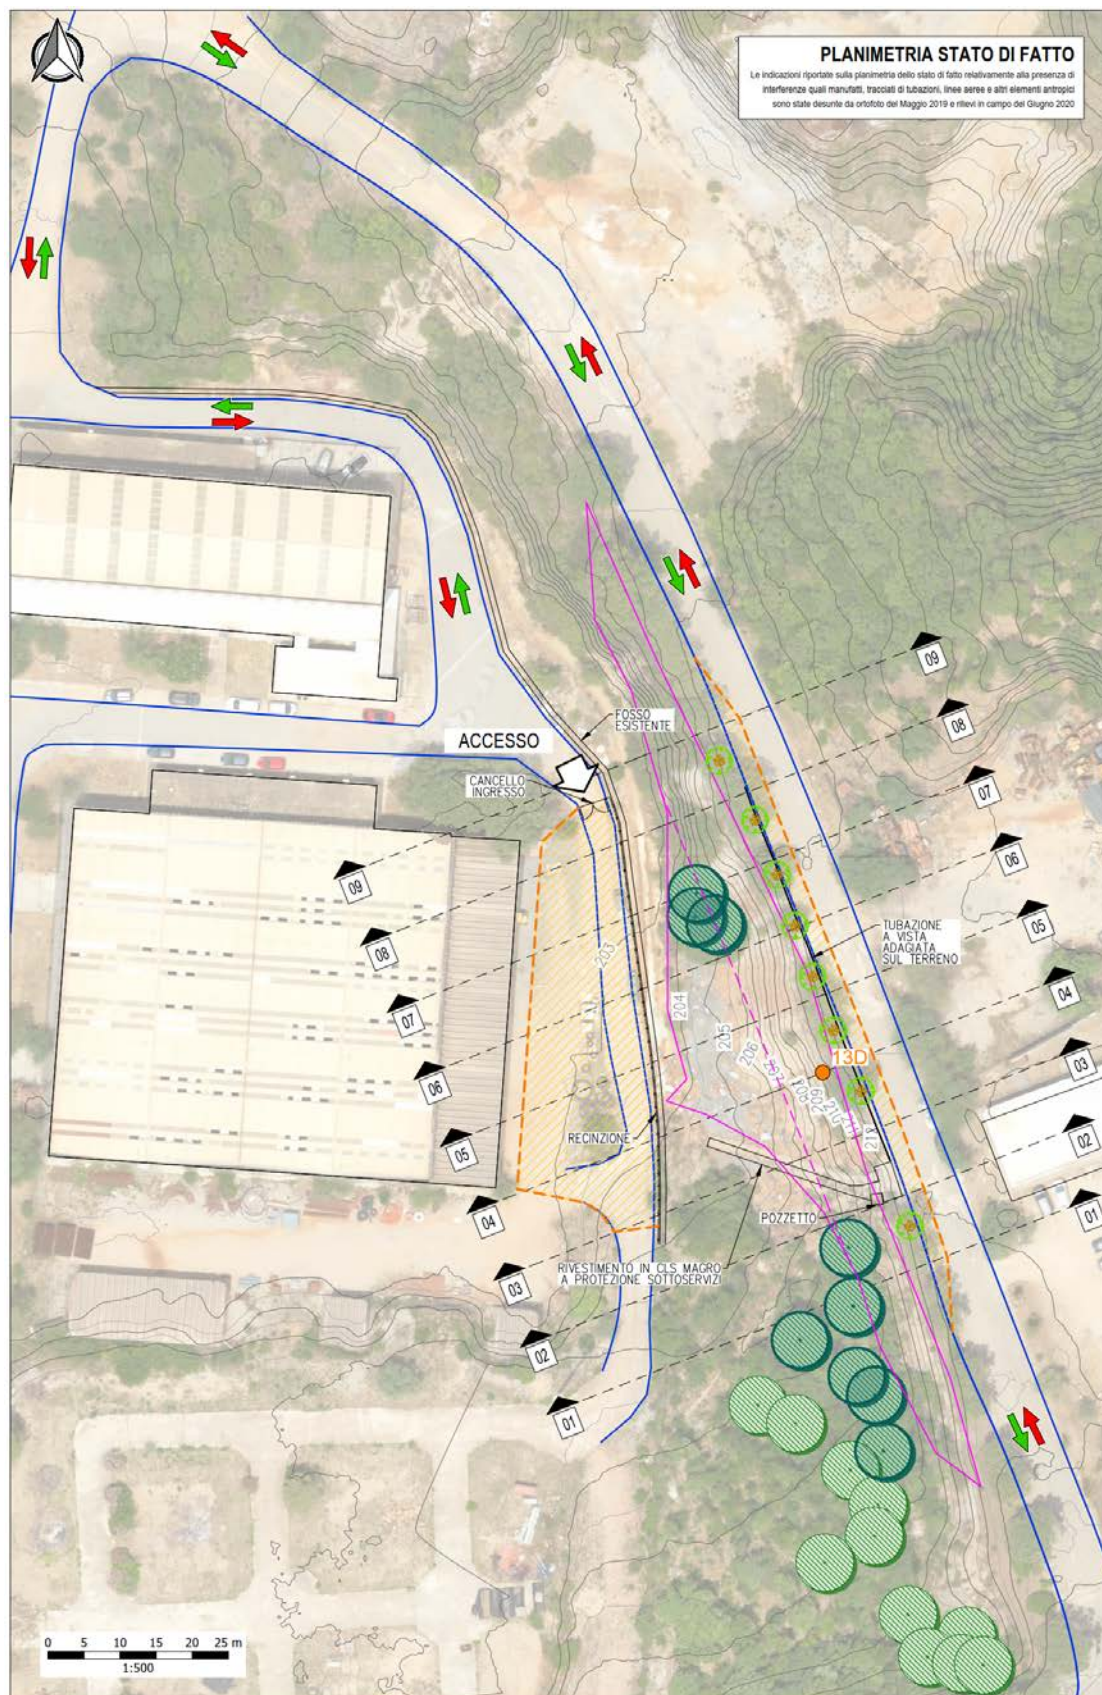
STRALCIO PLANIMETRIA STATO DI FATTO Cdp CP13
